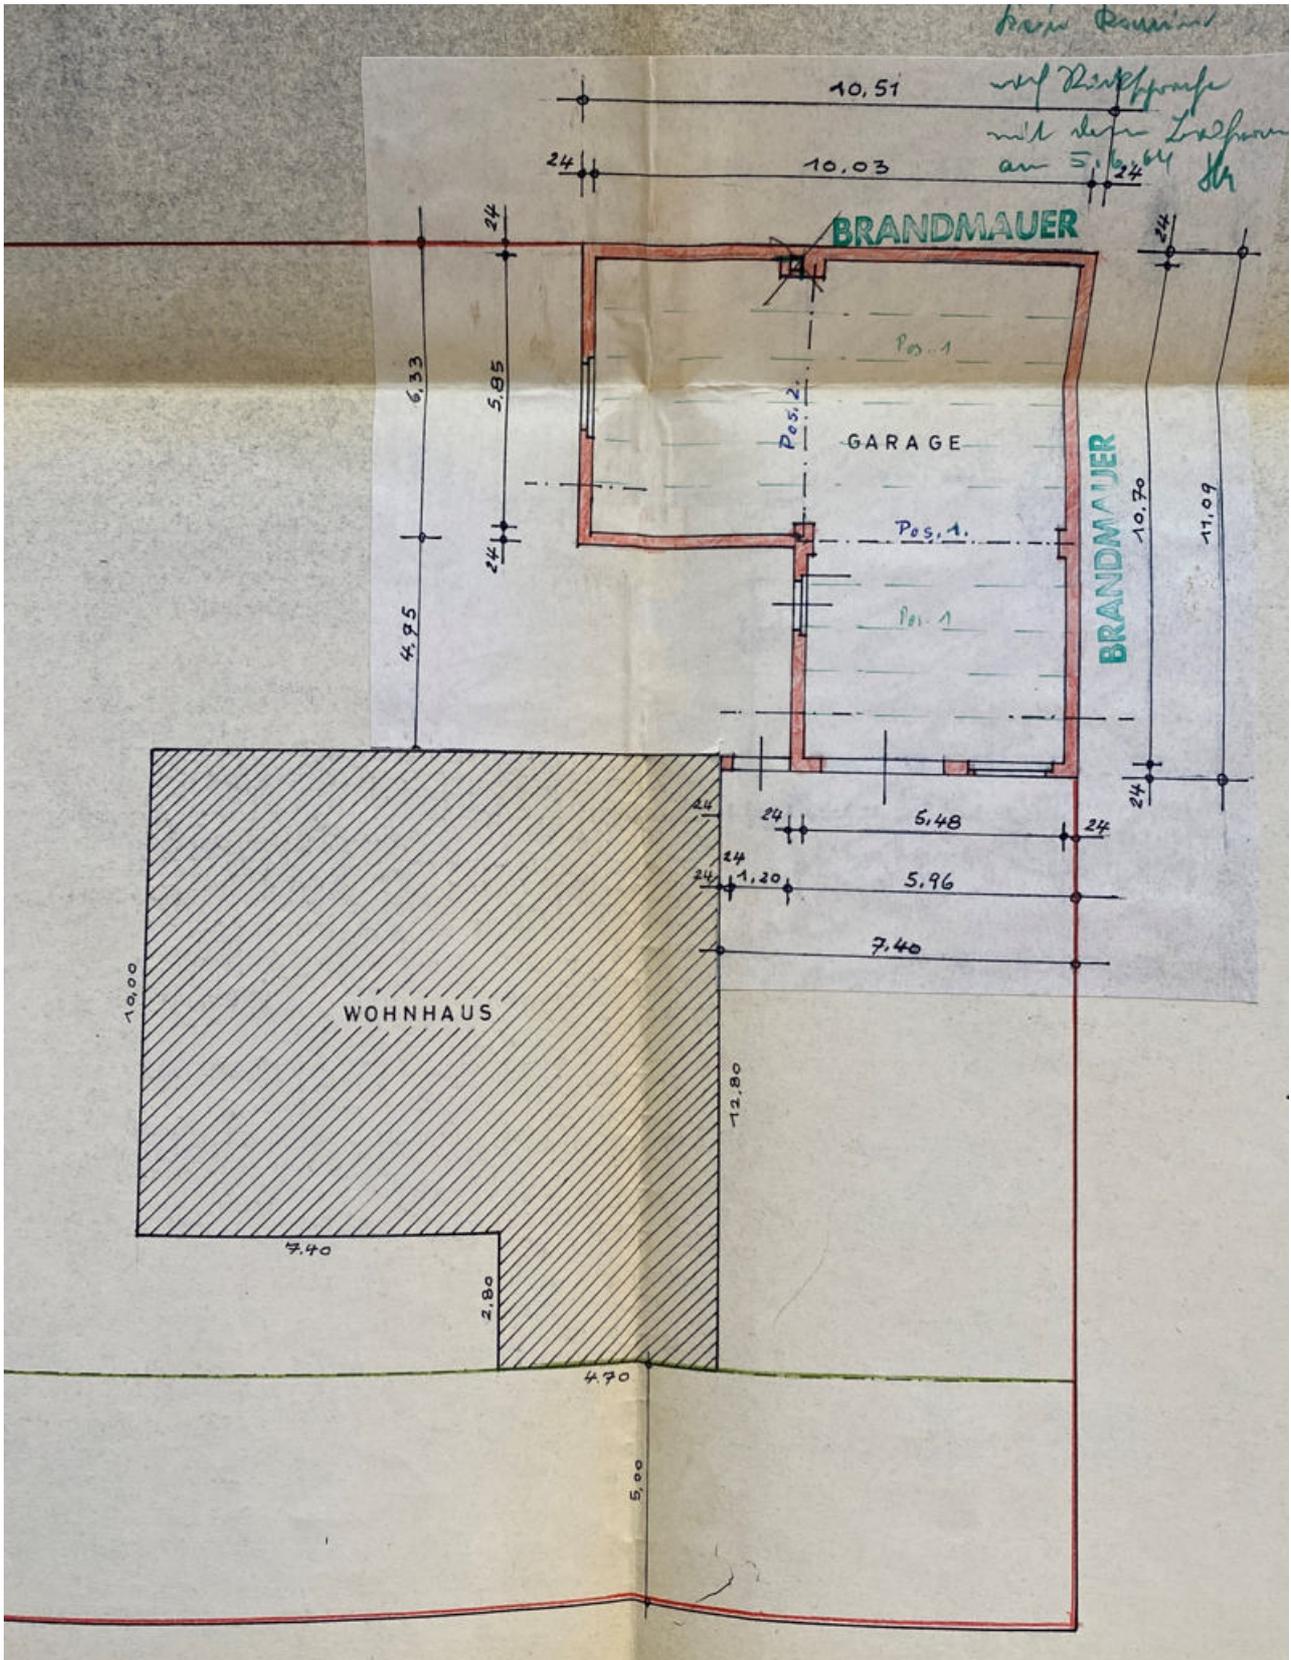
Grundriss Wohnhaus und Garage; Quelle: Bauakte Wetteraukreis
